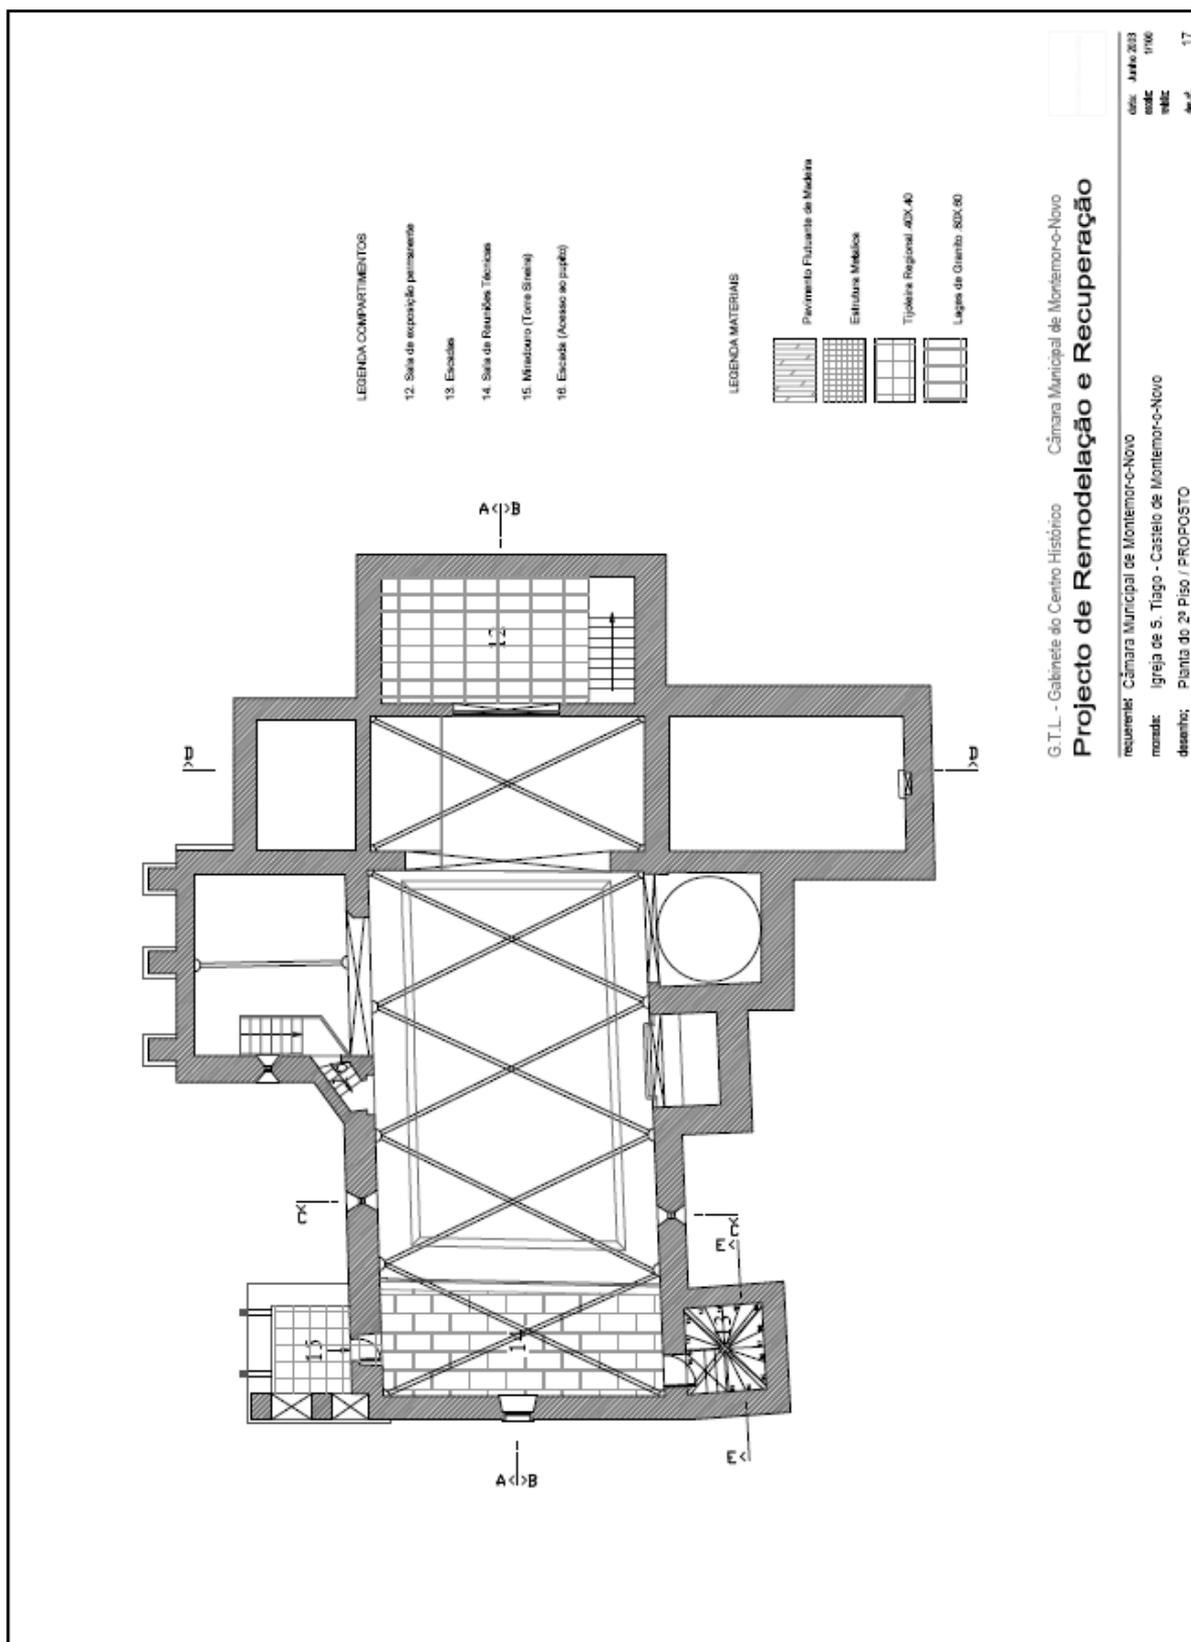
Planta da Igreja de São Tiago, 2º piso
